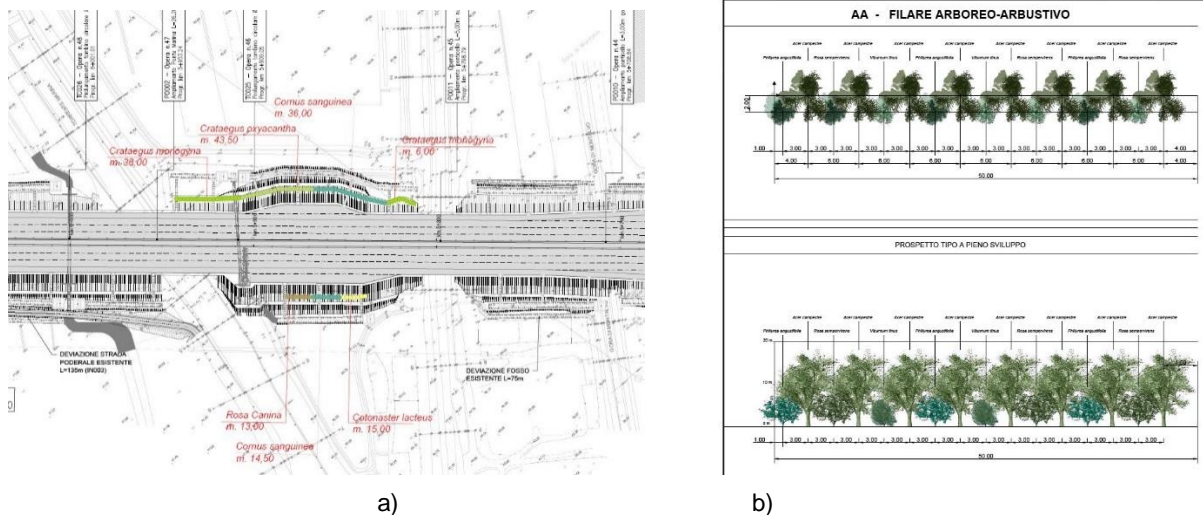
Opere a verde: stralcio planimetrico a); estratto abaco vegetazione b).
